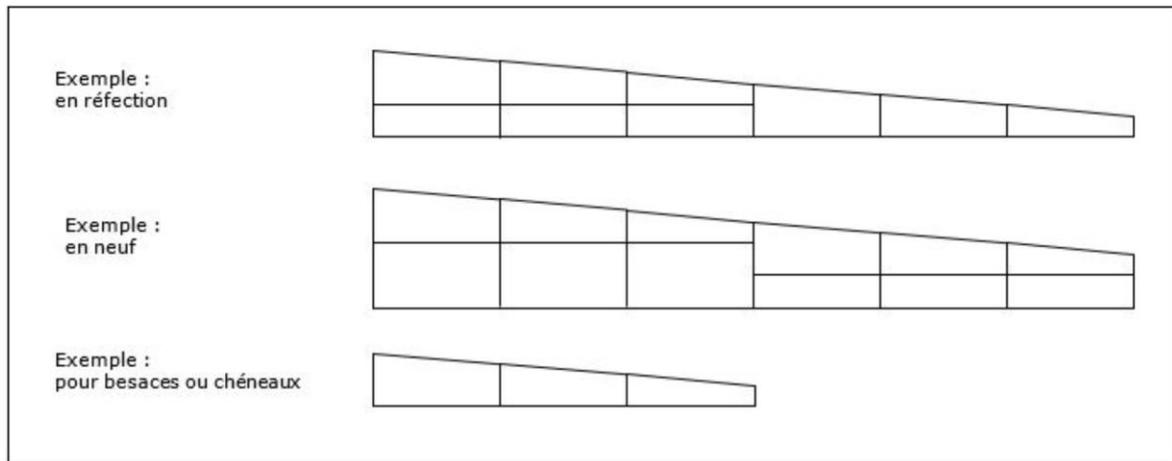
Coupe sur pente avec et sans isolant en lit inférieur
